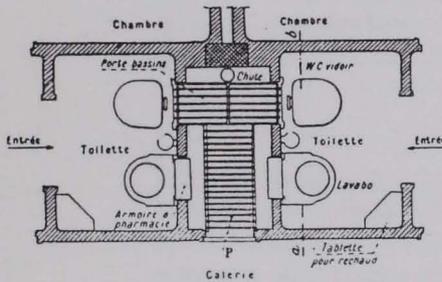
Grundriß von zwei Toiletten zwischen Bettzimmer und Flur. In der Mitte ein betretbarer Luftschacht. Krankenhaus „La Fondation Foch“, bei Paris. Arch. A. Fouqué
